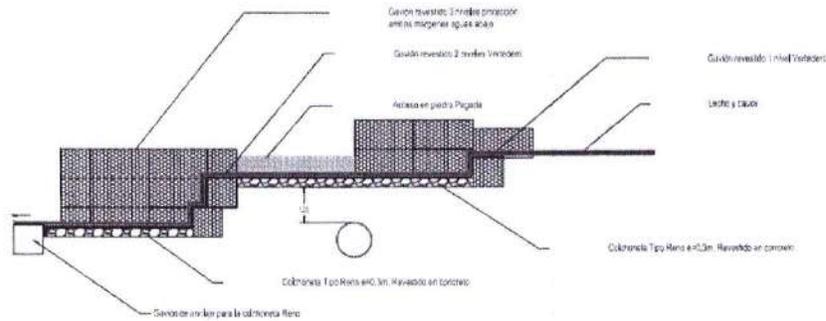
Esquema en perfil longitudinal de las obras a ejecutar en el Drenaje_NN_01, en el cruce subfluvial del sistema del Oleoducto Caño Limón – Coveñas (PK 492+625). Fuente: CENIT, 2022.
